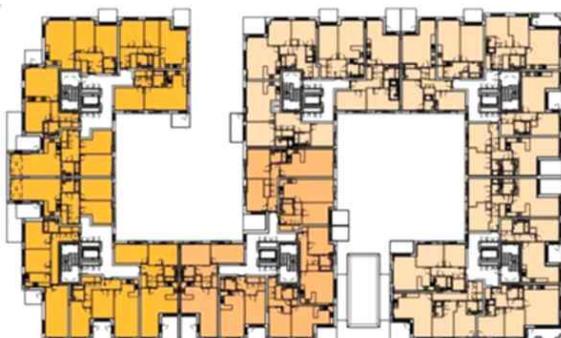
캠든 코트야즈 기준층 평면도 [7]
